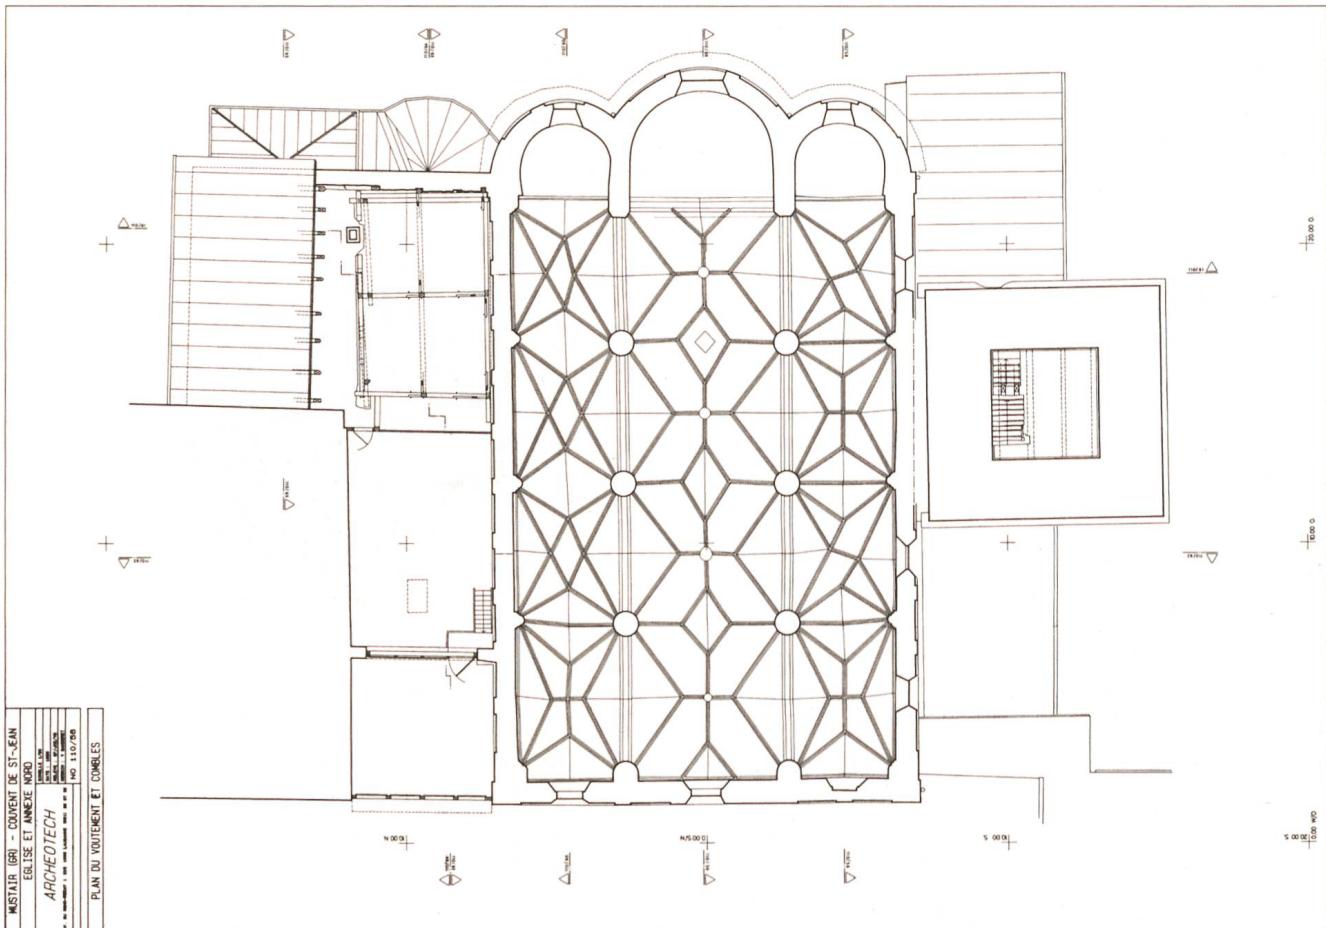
Grundriss der Klosterkirche St. Johann mit den direkt angrenzenden Gebäuden und Bauwerken.
